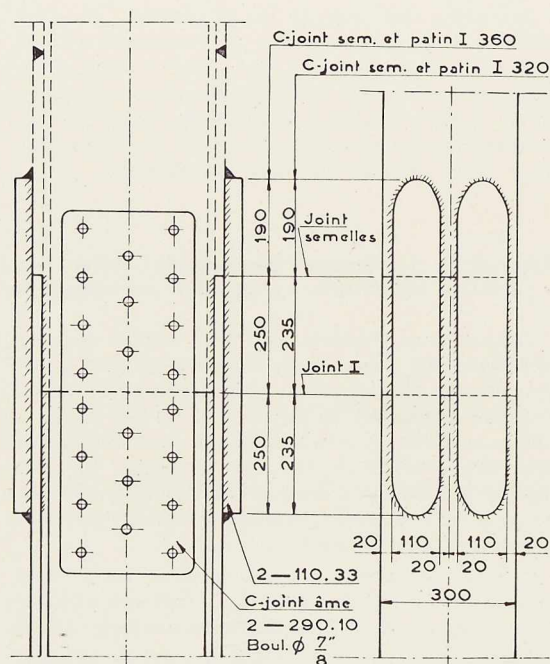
Détails de construction des joints du profil I et des semelles rapportées.
